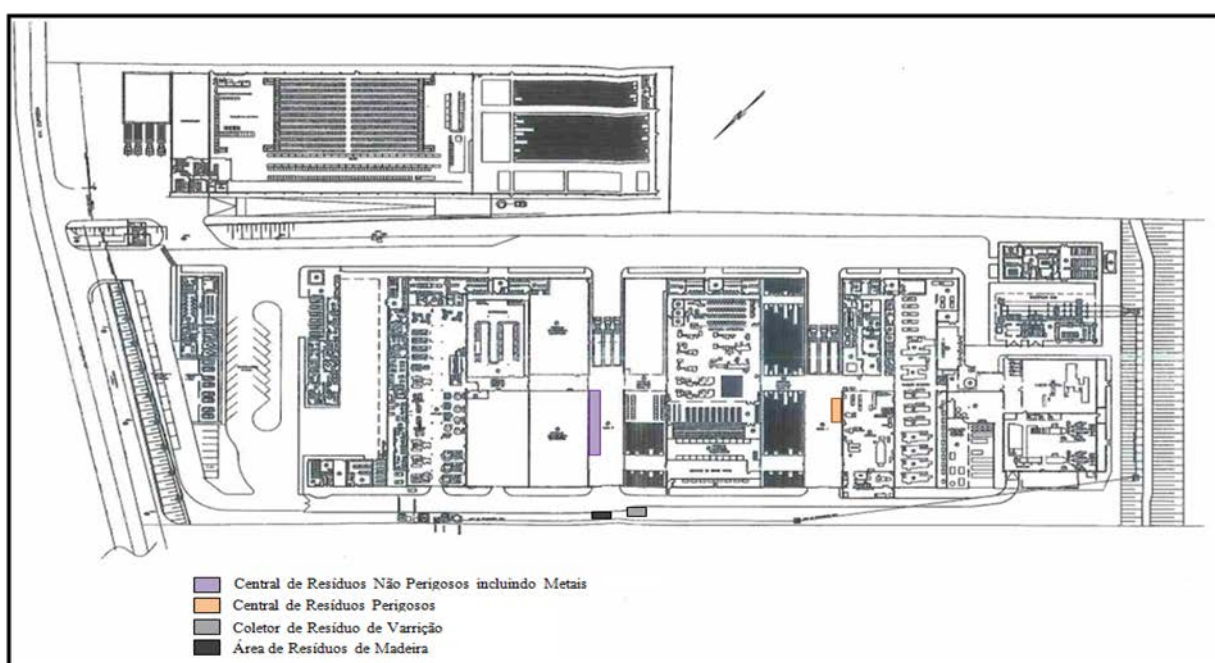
Planta Baixa da empresa indicando a atual localização das Centrais de Resíduos e Coletores
